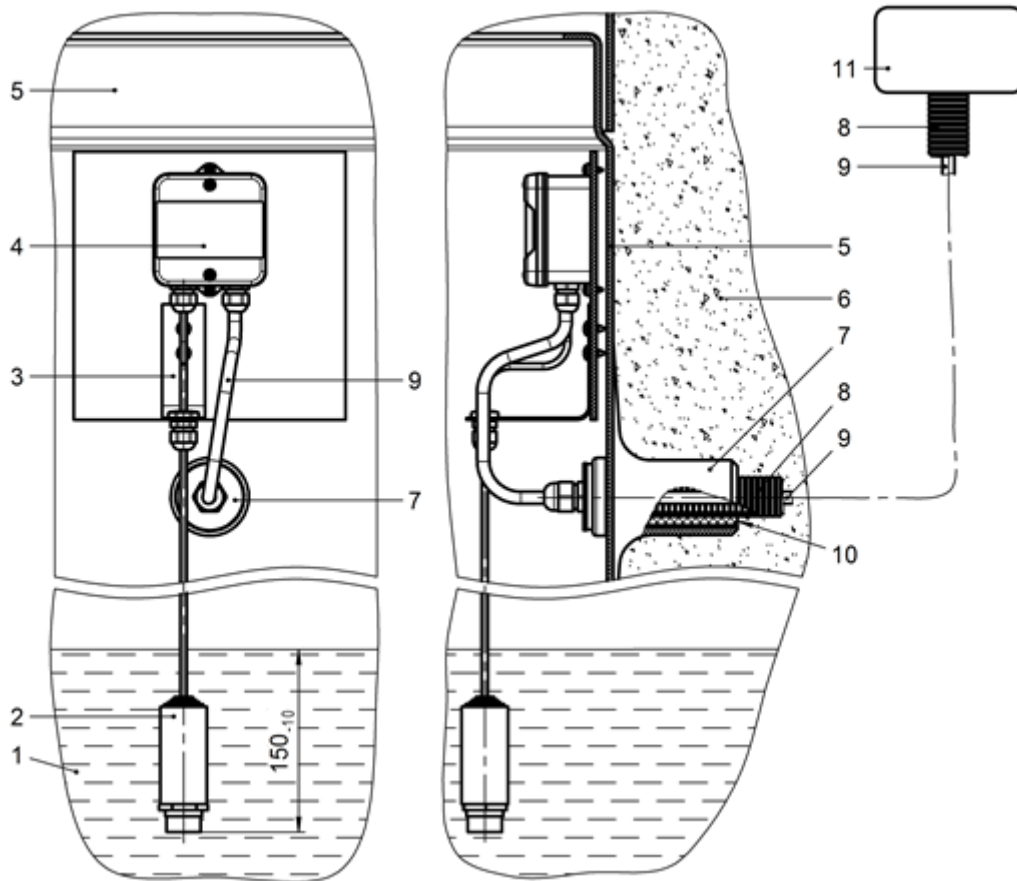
Крепление жироуловителя к железобетонной плите
